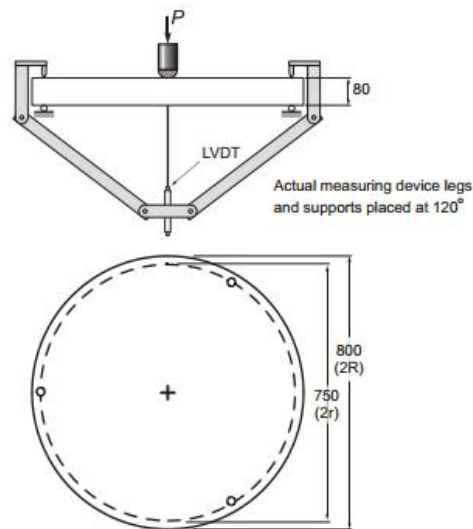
Essai sur dalle circulaire (de Montaignac et al., 2013)
